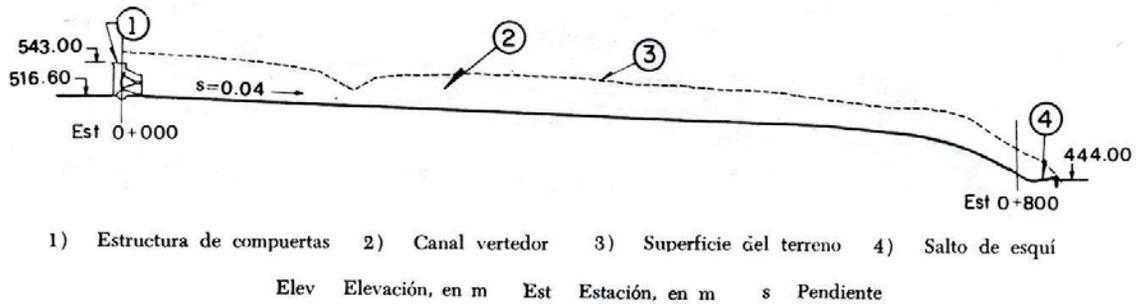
(a). Sección longitudinal del vertedor. Presa La Angostura.
